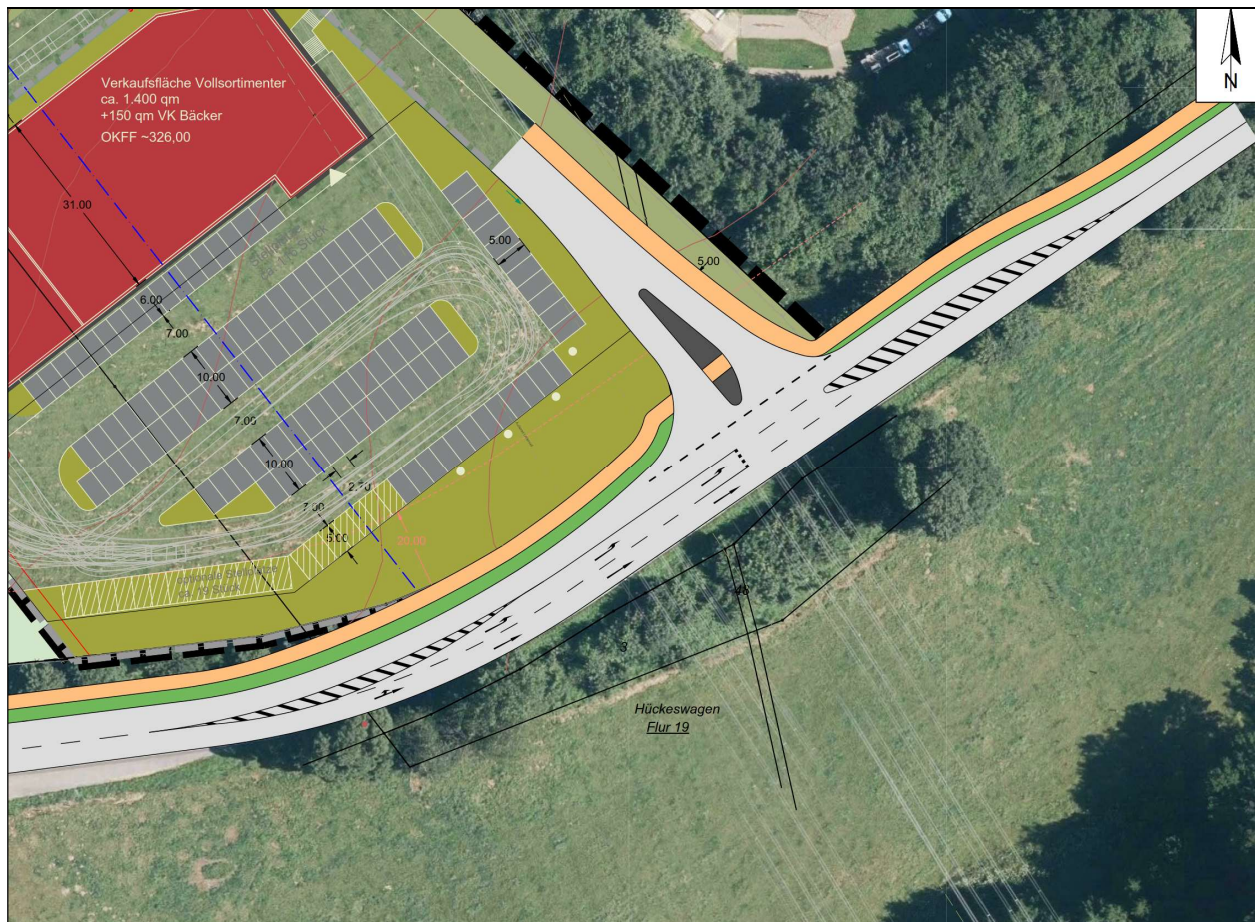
Verkehrstechnische Skizze – Lageplan Zufahrt Vorhabengrundstück
